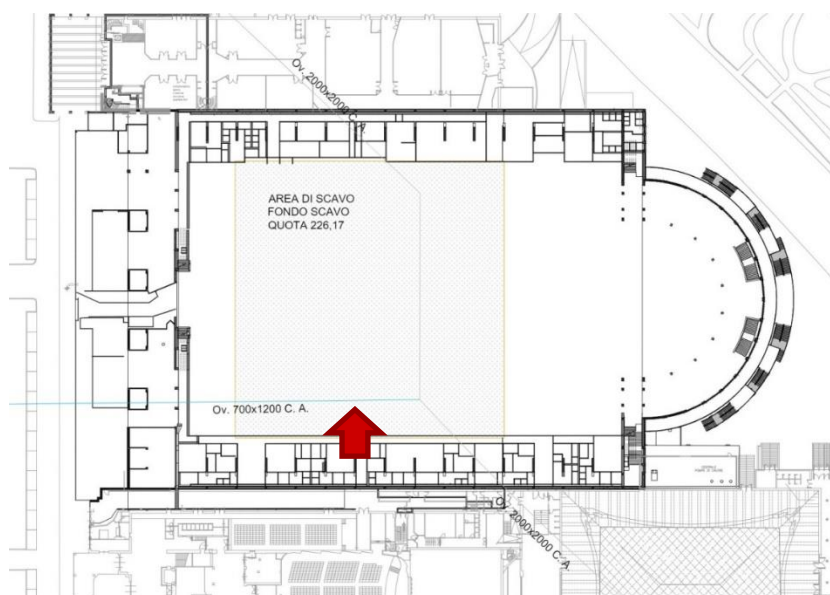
Planimetria rete fognaria – bianca profonda e innesto interferente
